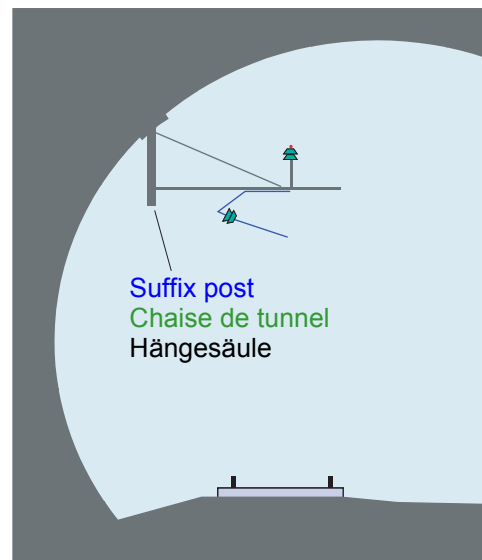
Tunnel support - Suspension sous tunnel - Tunnelstützpunkt
